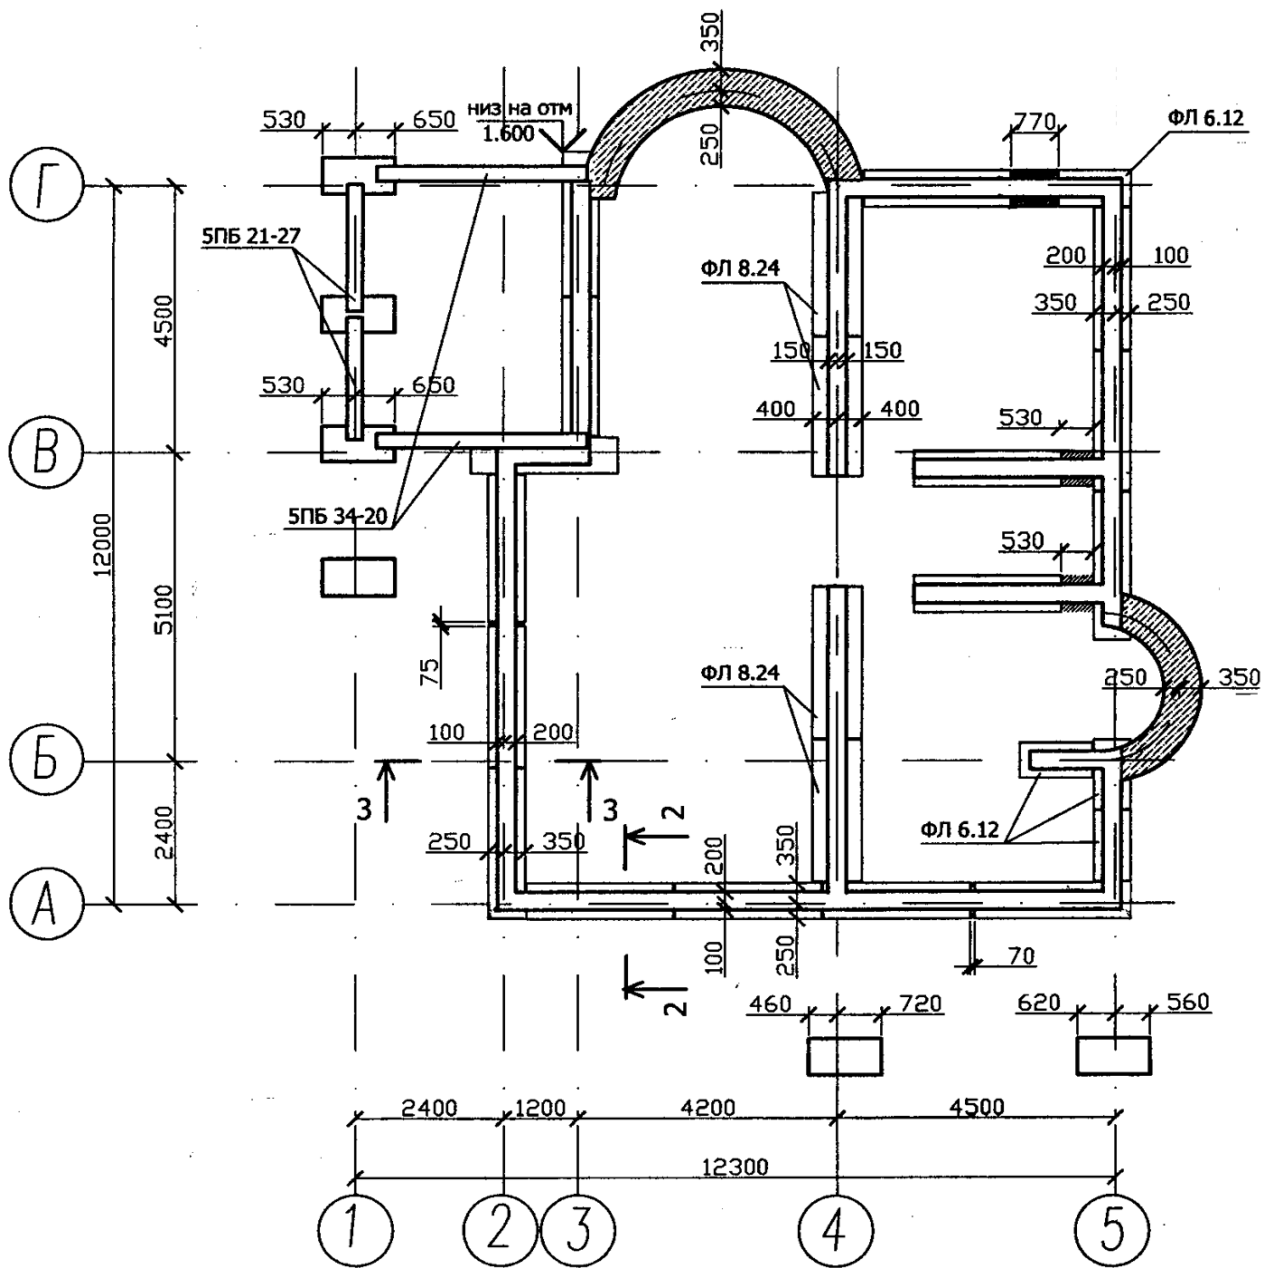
Пример выполнения плана столбчатого фундамента
